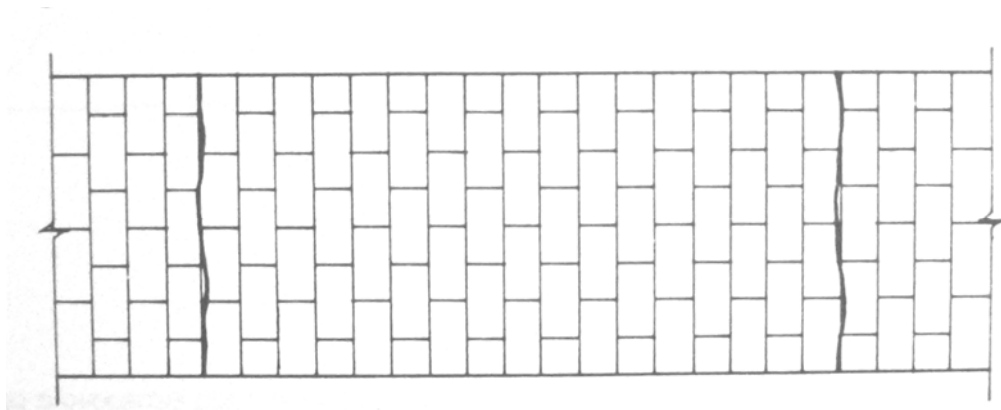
Fissuras regularmente espaçadas em piso externo, devidas a movimentações térmicas do piso. (Fonte: THOMAZ)
